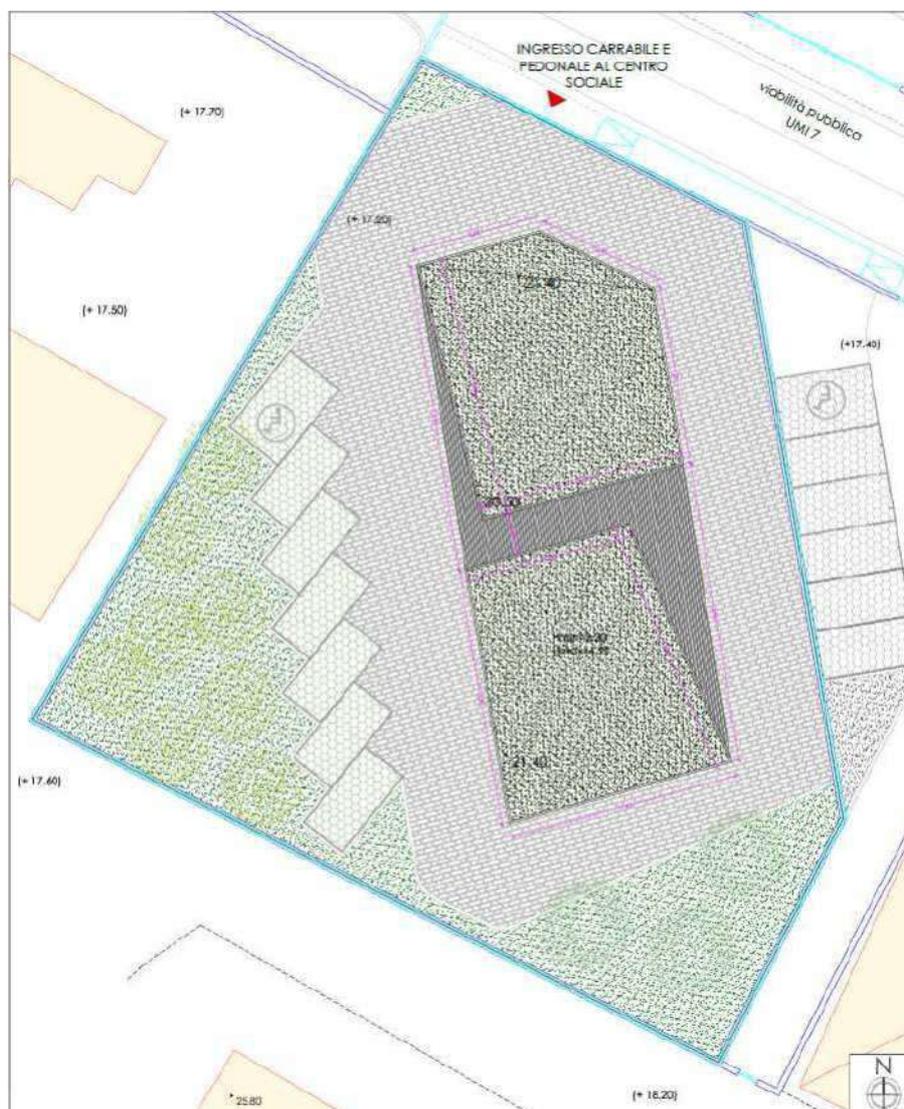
stralcio planimetrico del centro di aggregazione sociale
